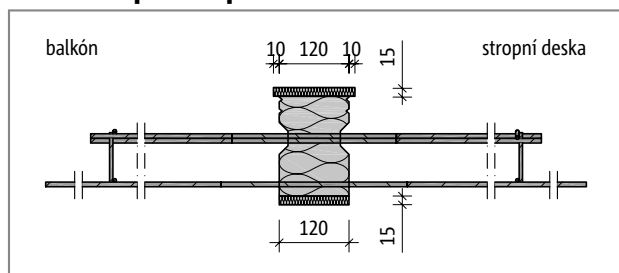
Schöck Isokorb® typ EQXT2: Půdorys prvku
